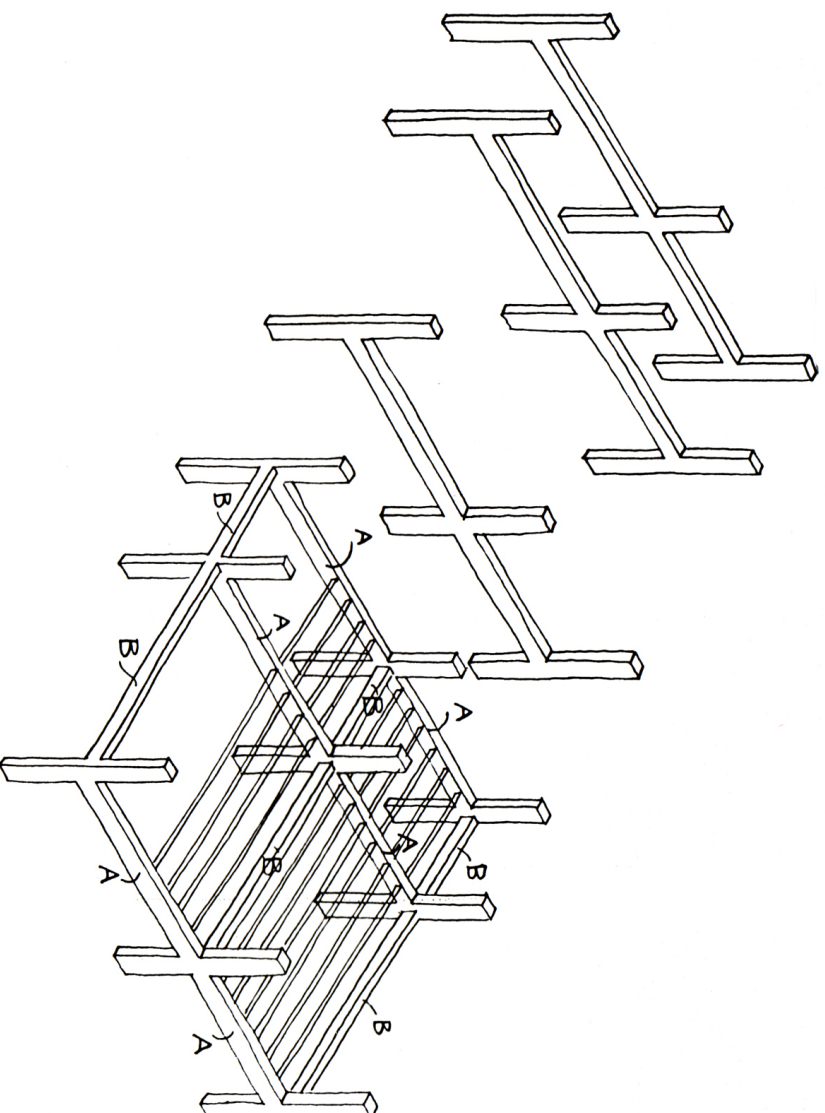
/3 EDIFICIO A SETTI – DISPOSIZIONE ARMATURE
